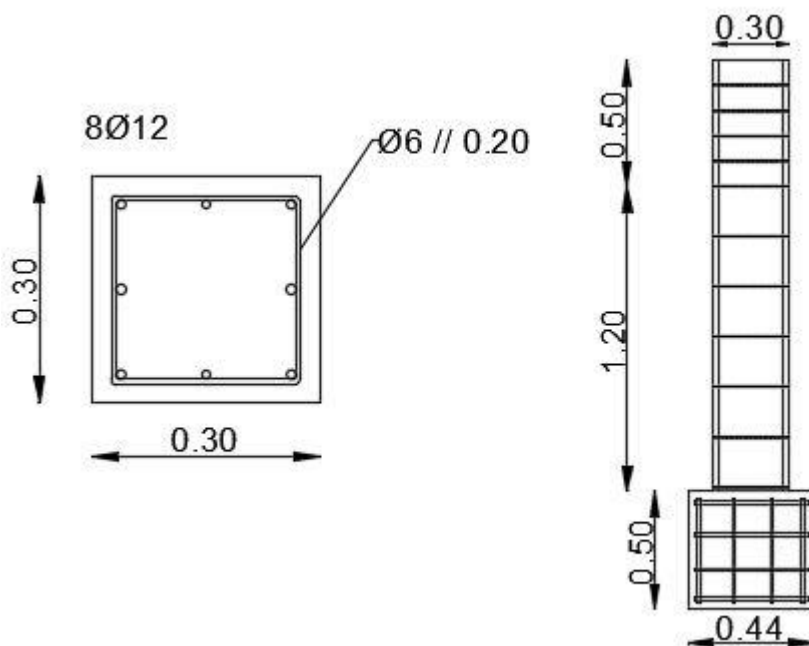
a) Secção Transversal; b) disposição construtiva
